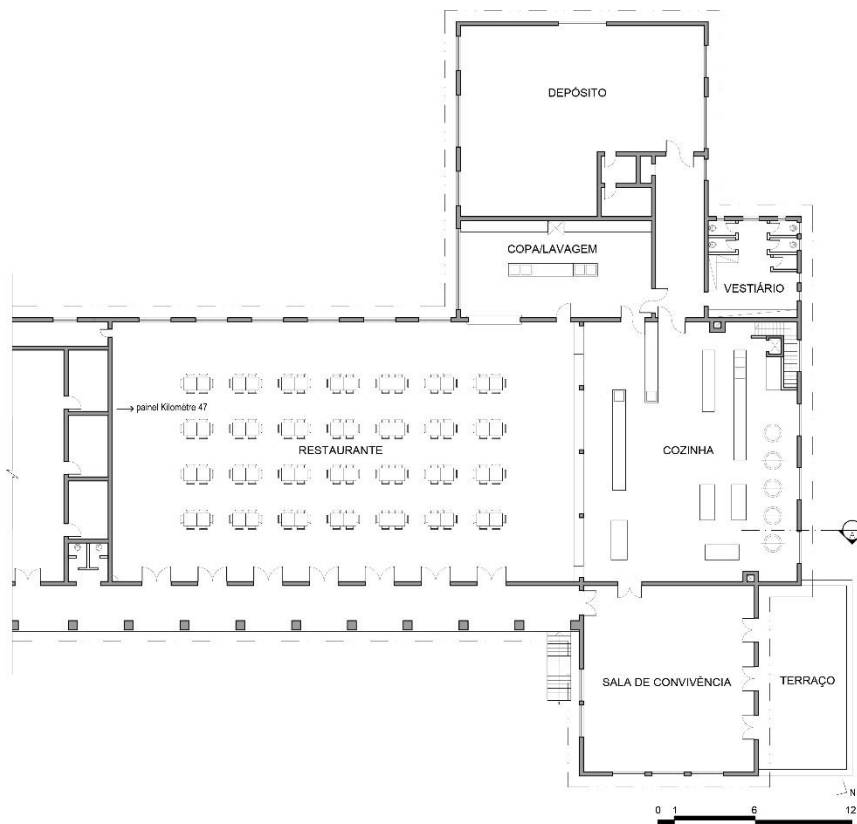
Planta baixa do refeitório. Desenho Renan Santana, bolsista PIBIC, 2021.
